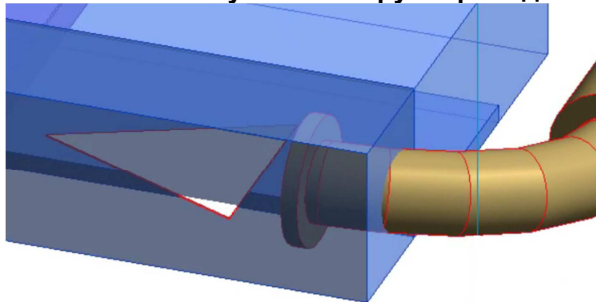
Смещенное соединение воздухопровода с оборудованием
